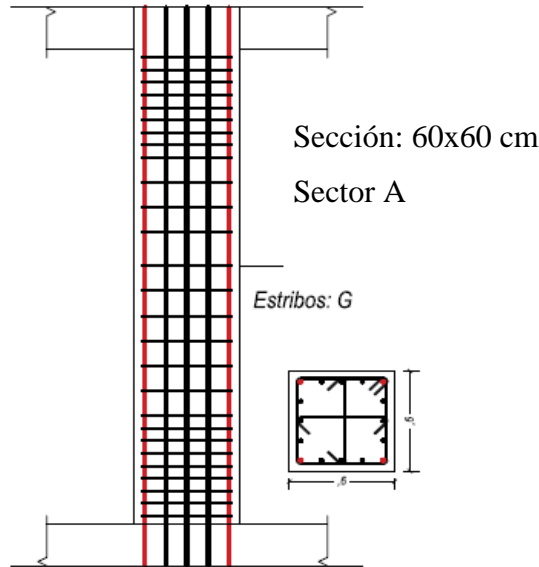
Detalle de Columna en Base Aislada (A)
